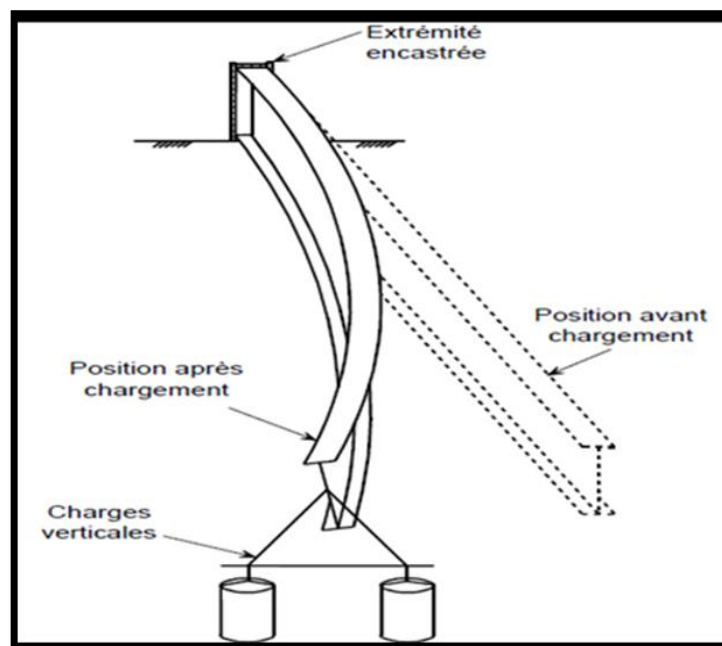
Mise en évidence du déversement d'une poutre en console.
